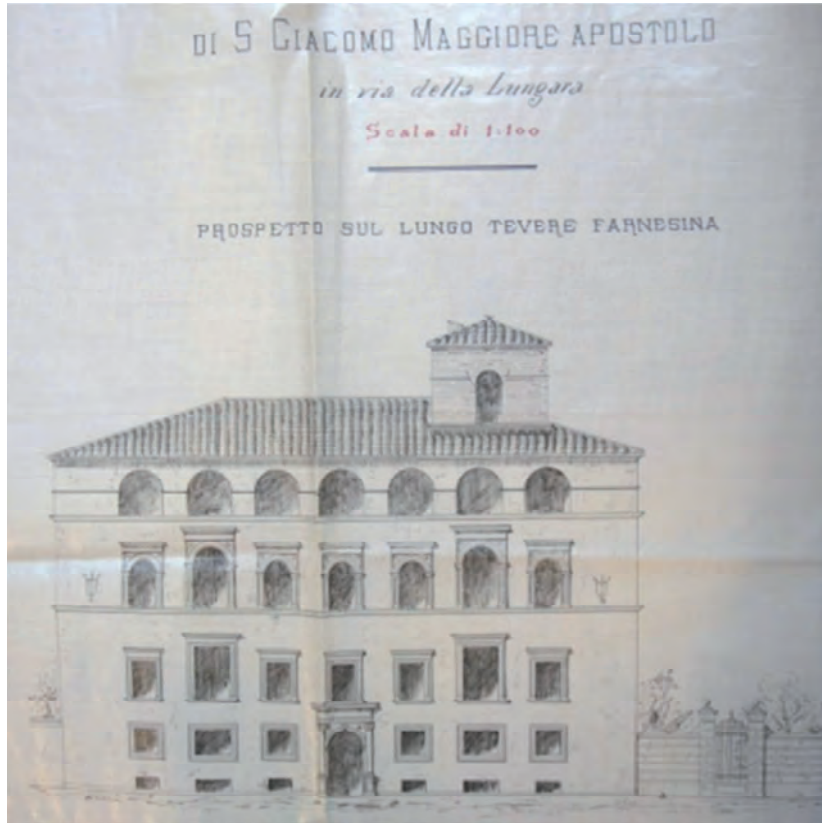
Progetto preliminare redatto dall'Ing. Casini nel 1903. Prospetto sul Lungotevere [B.2].
